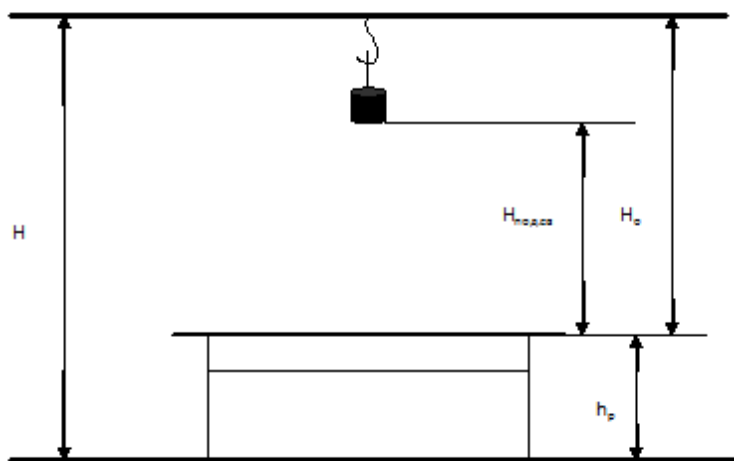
Схема к определению высоты подвеса светильника
